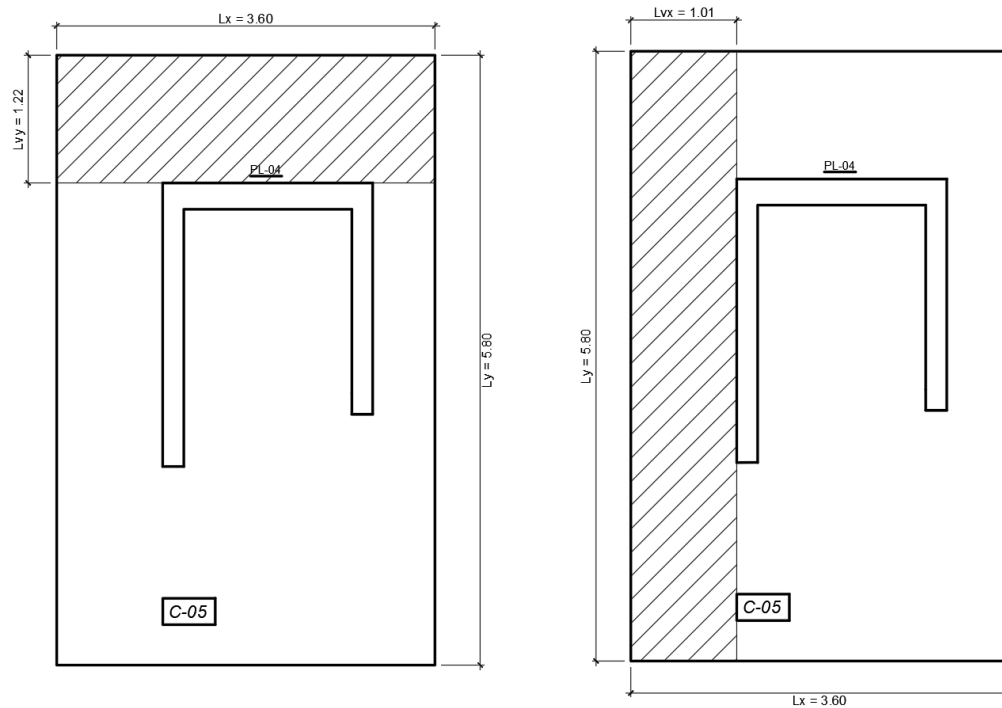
7. Áreas en voladizo en la zapata Z-04
